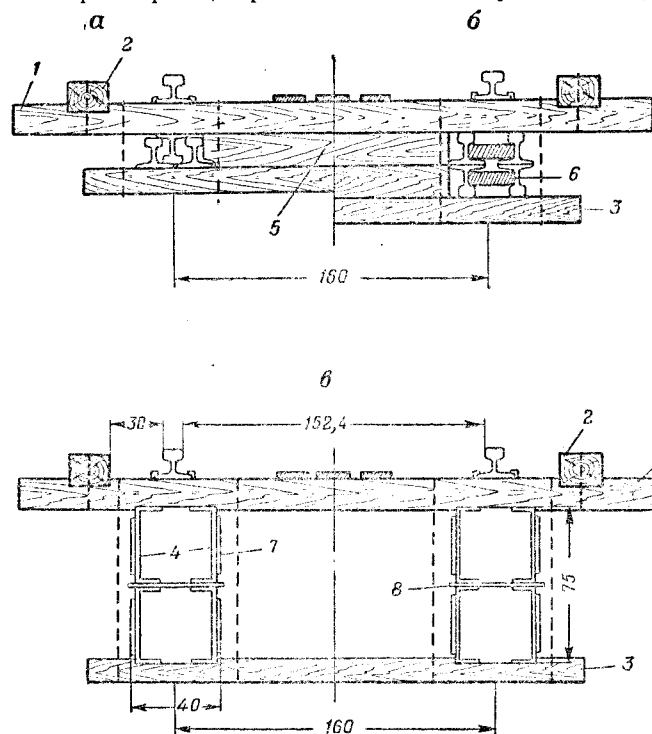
Пакетные пролетные строения из рельсов и швеллеров:
